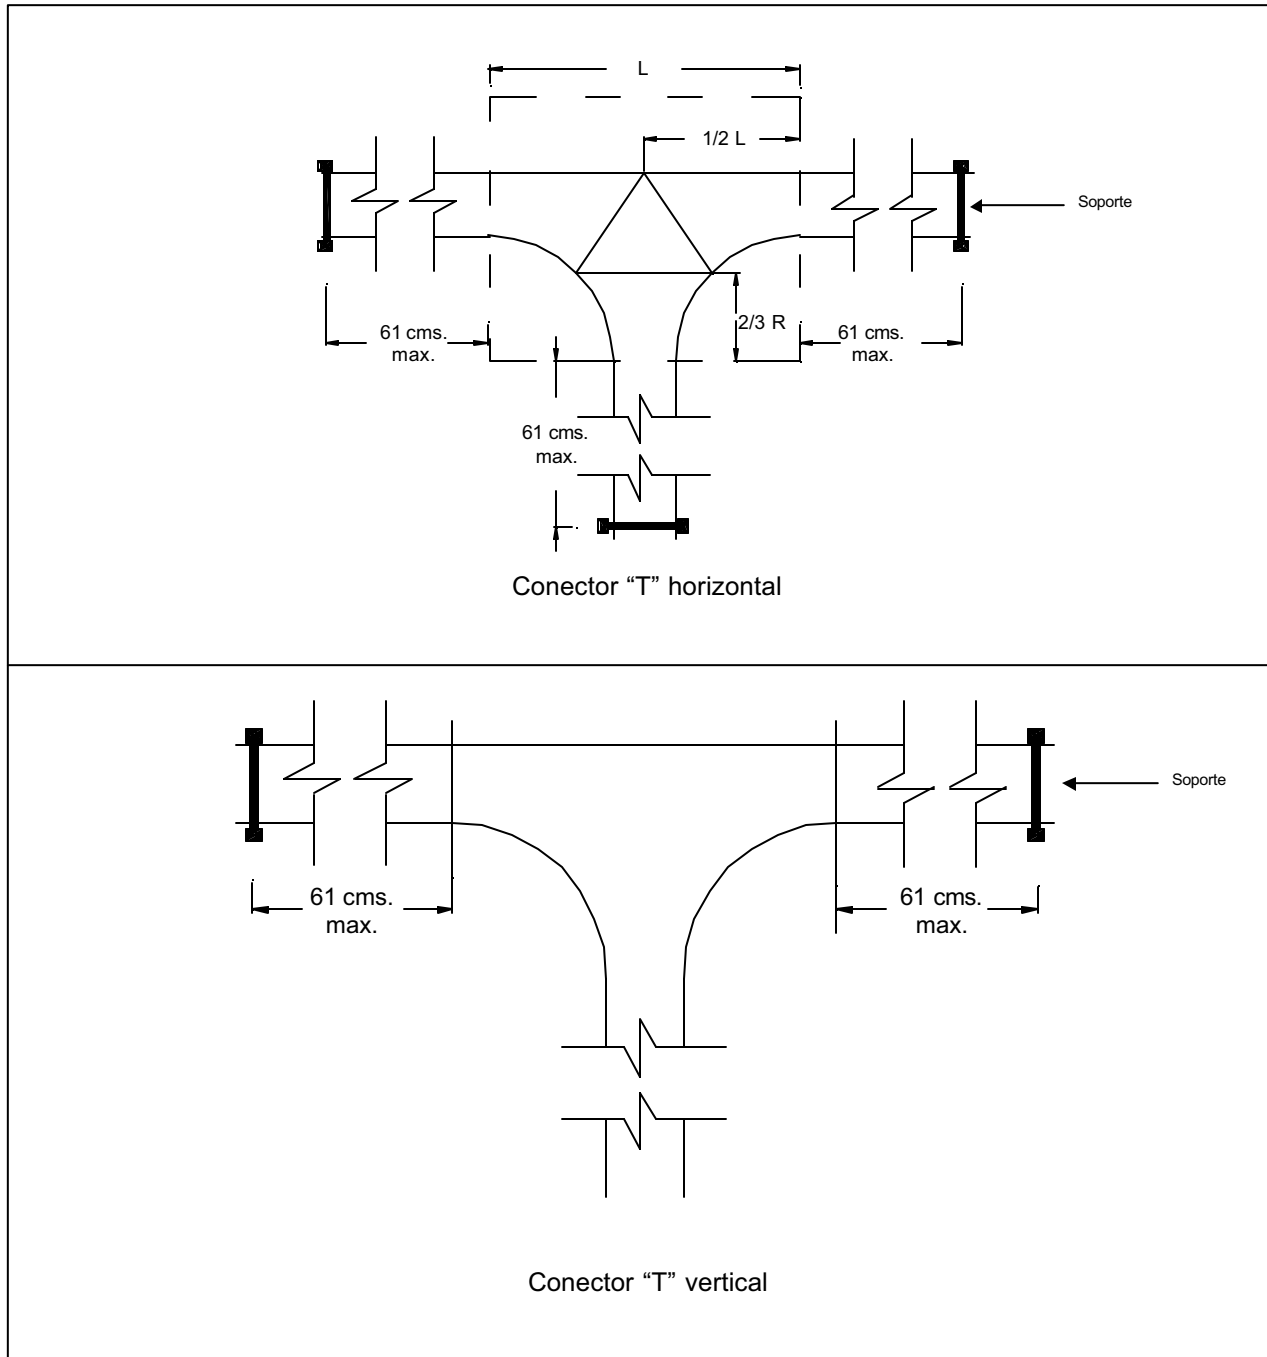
Localización de soportes para escalera portacables.
